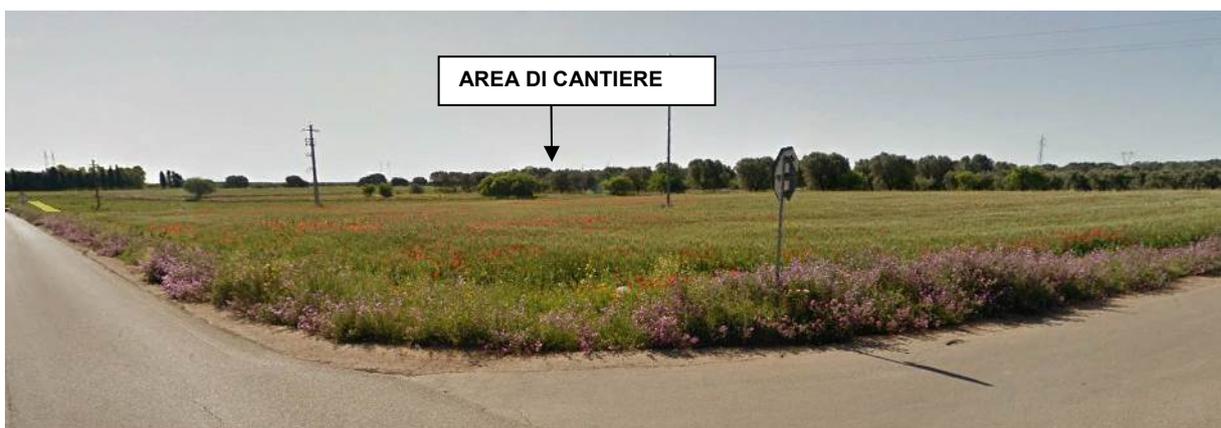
Vista del sito su cui è prevista l'area di cantiere, lungo la SP-107: l'area, di facile accessibilità, sarà utilizzata dalle maestranze impegnate nella realizzazione dell'impianto e a fine cantiere sarà dismessa.
